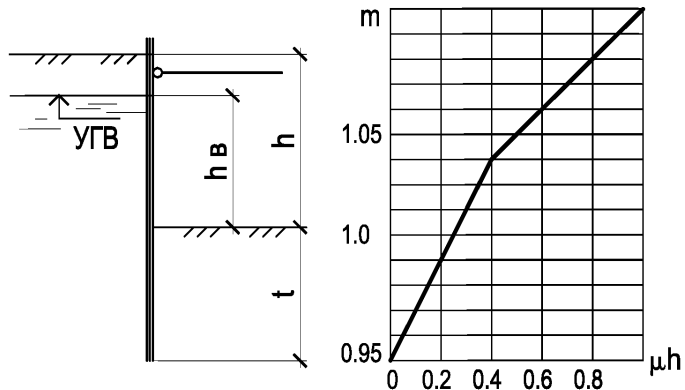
Схема и график для определения коэффициента условий работы в расчете устойчивости шпунтового ограждения на местности, не покрытой водой
